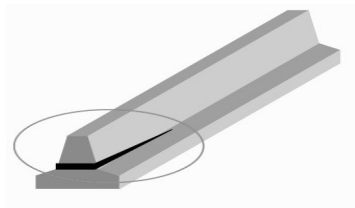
Esquema de Vigota com fissuração horizontal (Araújo,2003).
